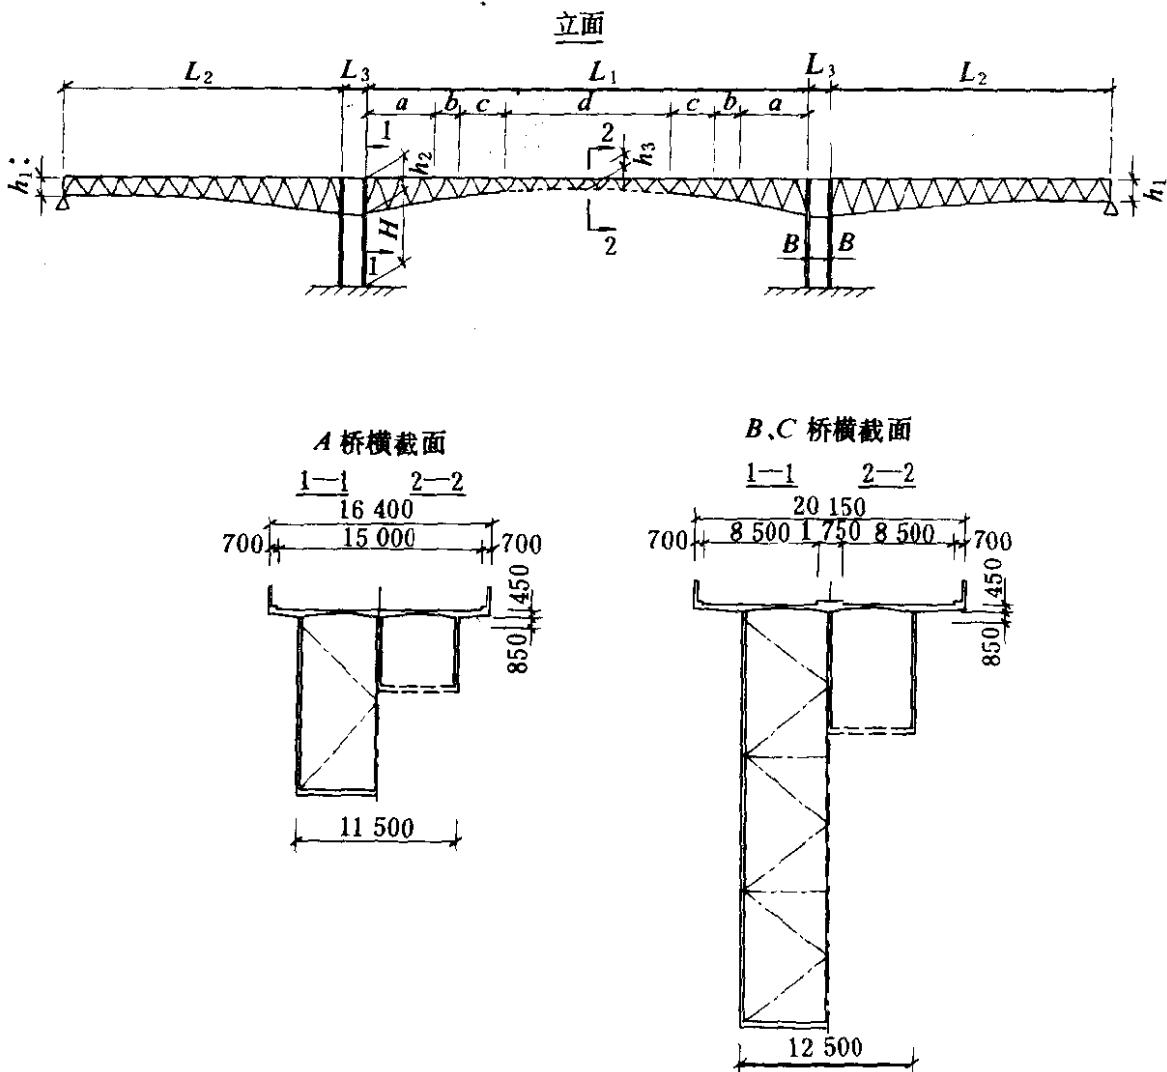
平面钢桁架组合梁桥构造(尺寸单位:mm)
